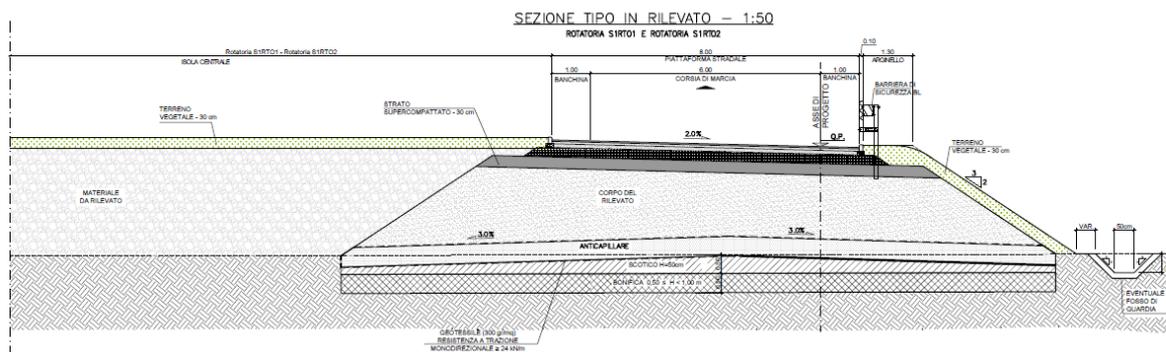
Sezione tipo S1RT02 senza pista ciclopedonale
